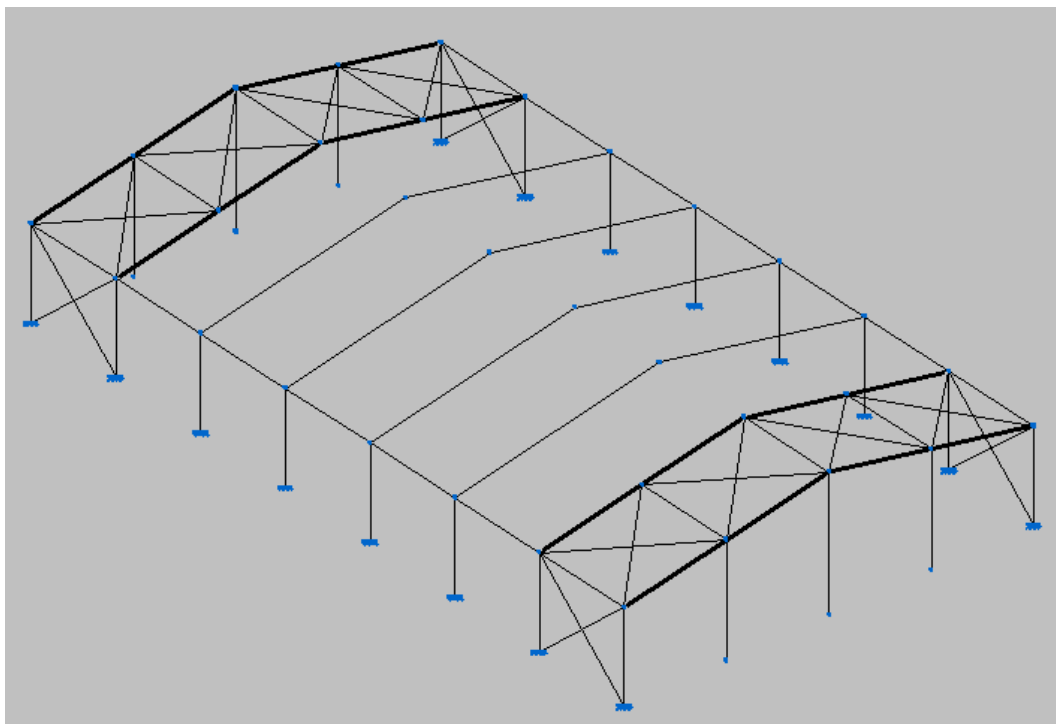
Vista 3D. Estructura con pilares frontales, viga de atado de cabeza de pilares y cruces de San Andrés
